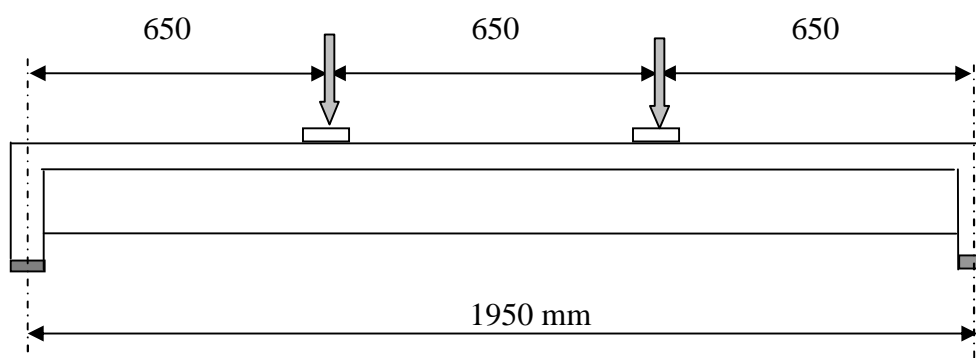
Geometría longitudinal y esquema de carga de las vigas
